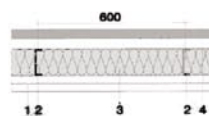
Пример монтажа внутреннего утепления стен с устройством пароизоляции
